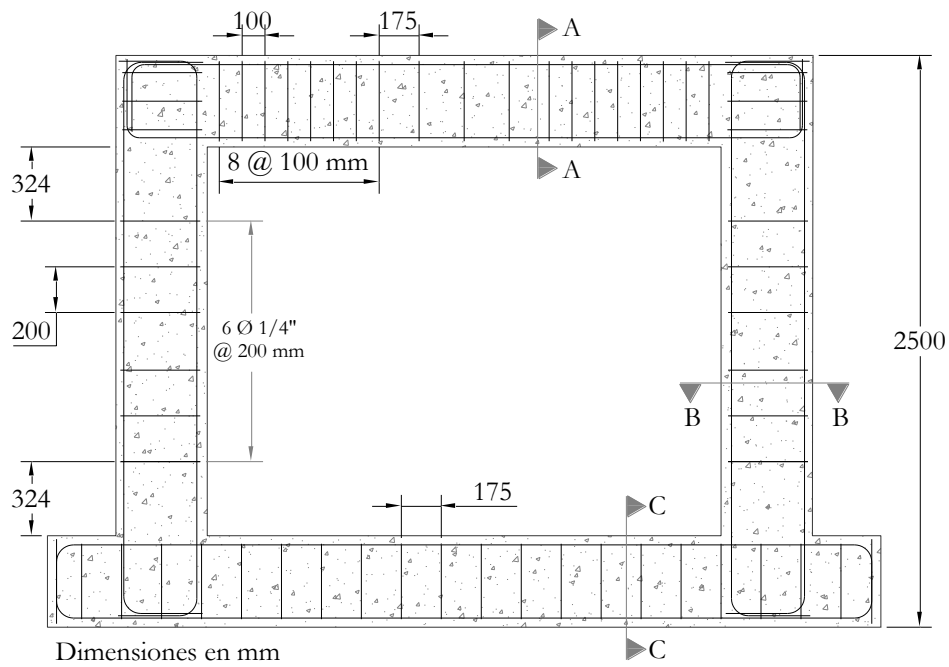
Detallado del refuerzo del pórtico *P2
